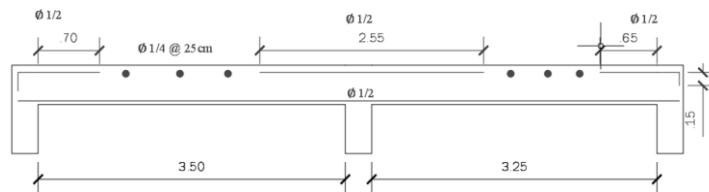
Detalle de armadura de losa aligerada vista de perfil
